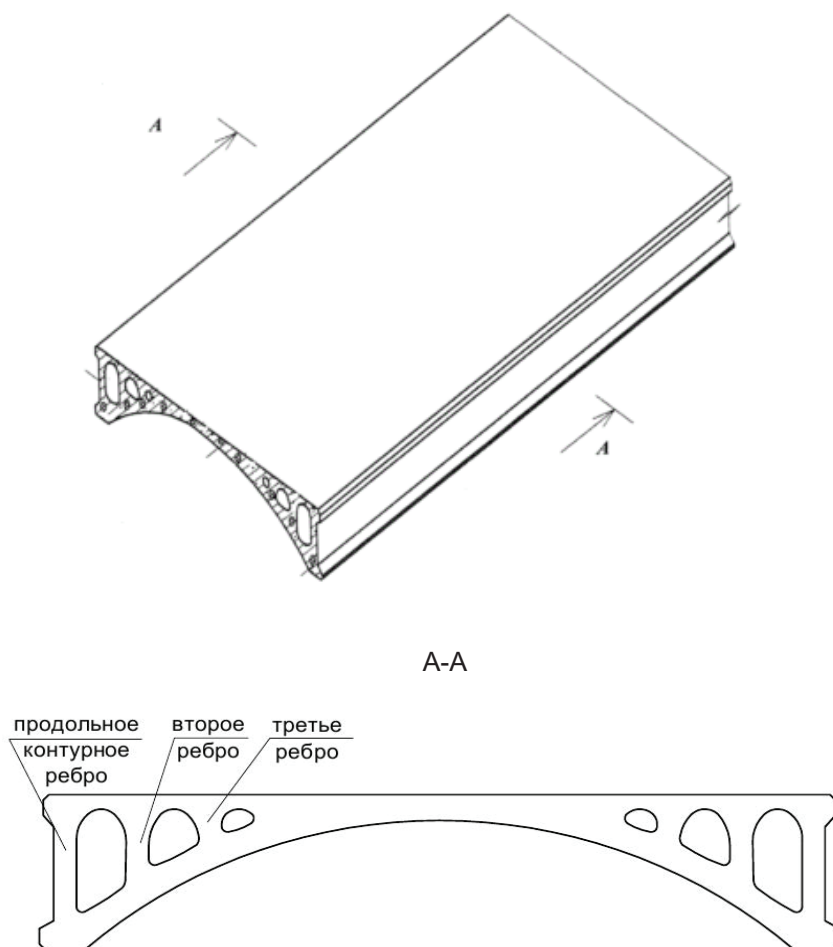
Конструктивное решение и поперечное сечение железобетонной плиты-оболочки
